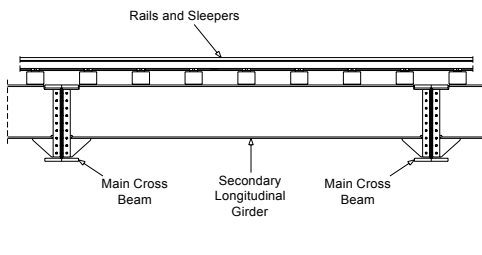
Ponte sul Panaro: vista laterale della trave longitudinale secondaria con sezione variabile
